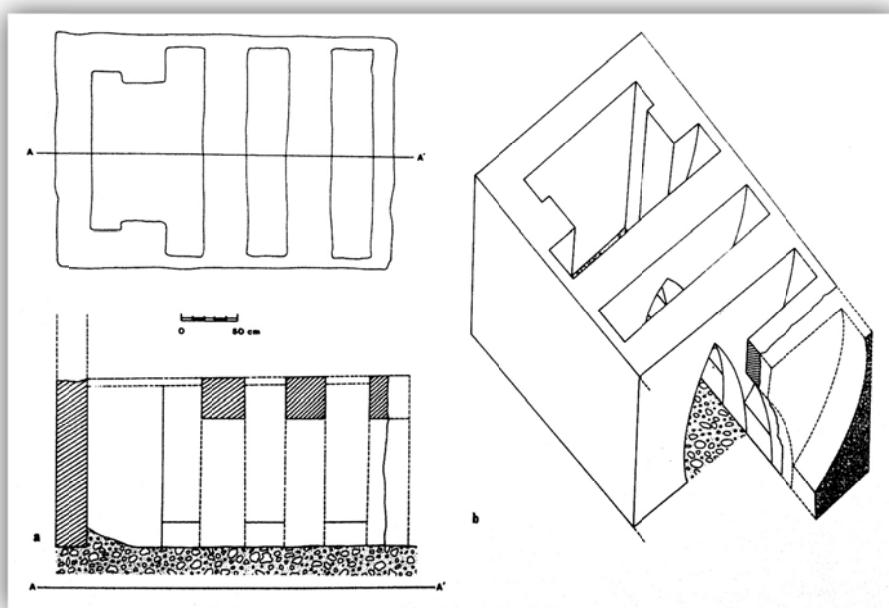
Izquierda: planta y sección. Derecha: reconstrucción. MOSTALAC CARRILLO 1987: 66.
